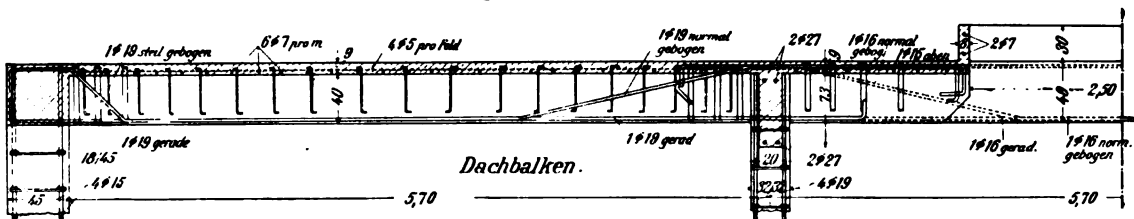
Dachlängenschnitt mit Ansicht der Dachrippen (zu Abb. 110).
